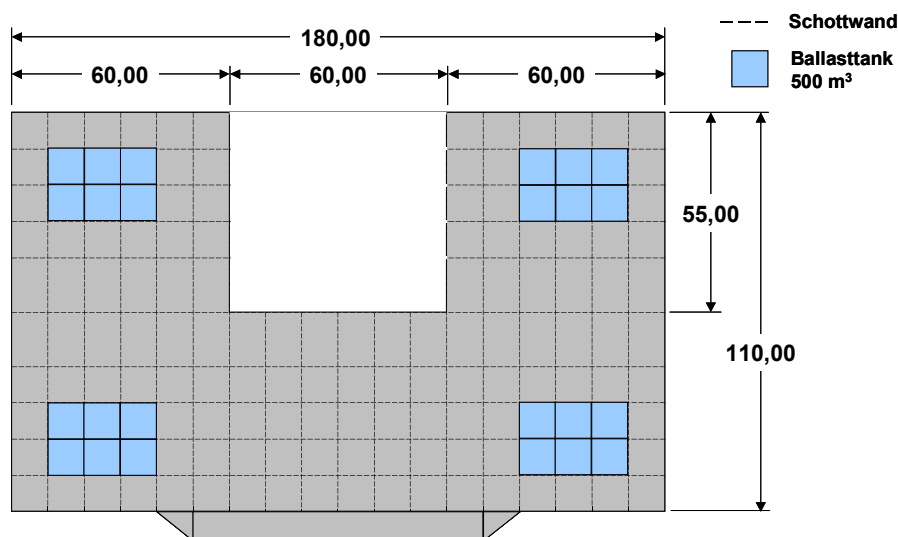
U-Barge: Hauptabmessungen
